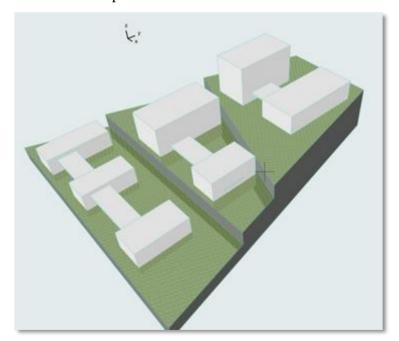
Esquema en perspectiva de propuesta arquitectónica - Elaboración propia
